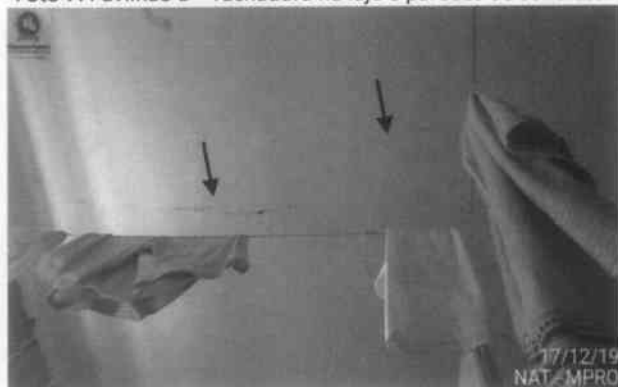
Pavilhão Vivência – trincas na laje de diversas celas.
